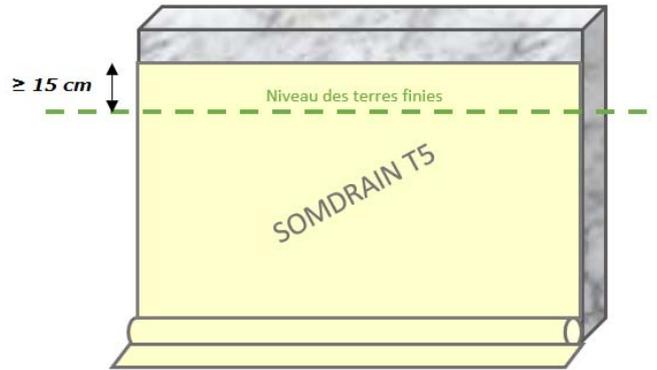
positionnement du SOMDRAIN T5 sur support en béton banché ≥ 15 cm
